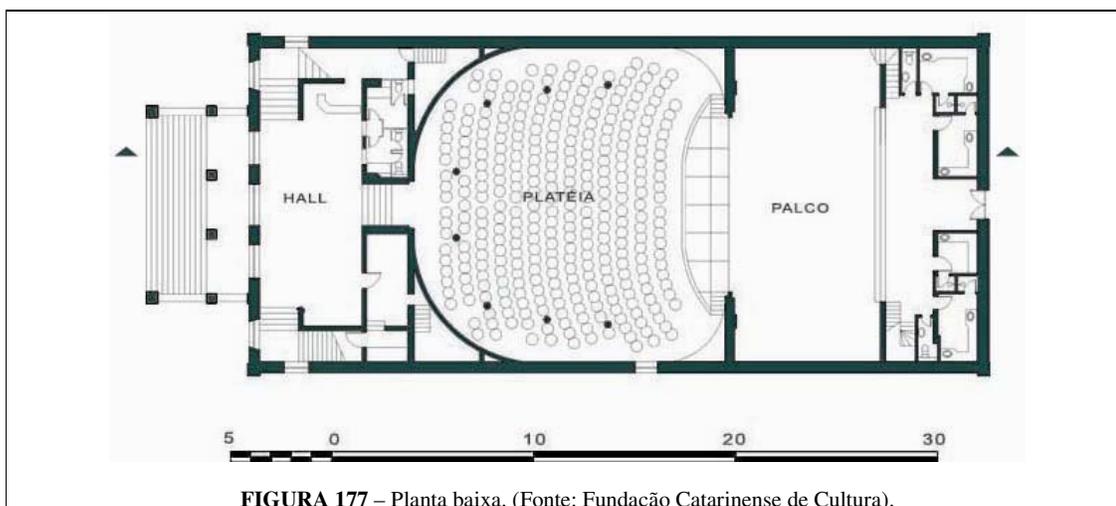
Planta baixa. (Fonte: Fundação Catarinense de Cultura).
